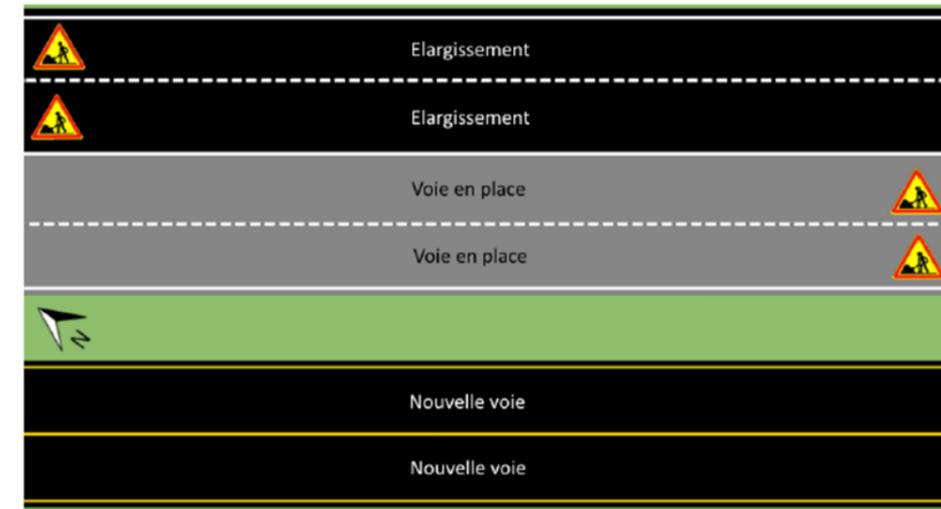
Principe d'un élargissement sur place à l'Est de la chaussée actuelle
